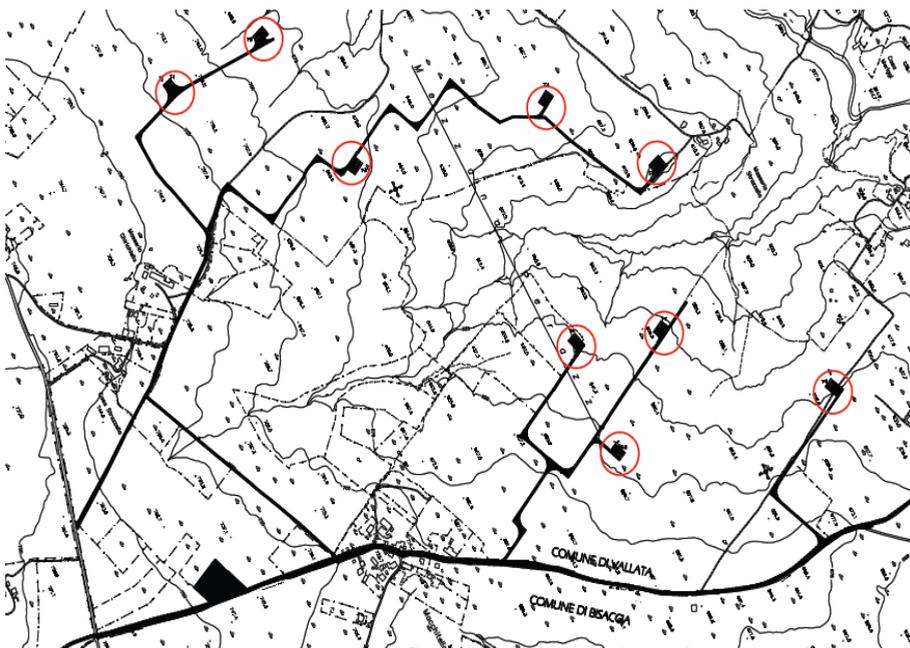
Planimetria e posizionamento degli aerogeneratori.
